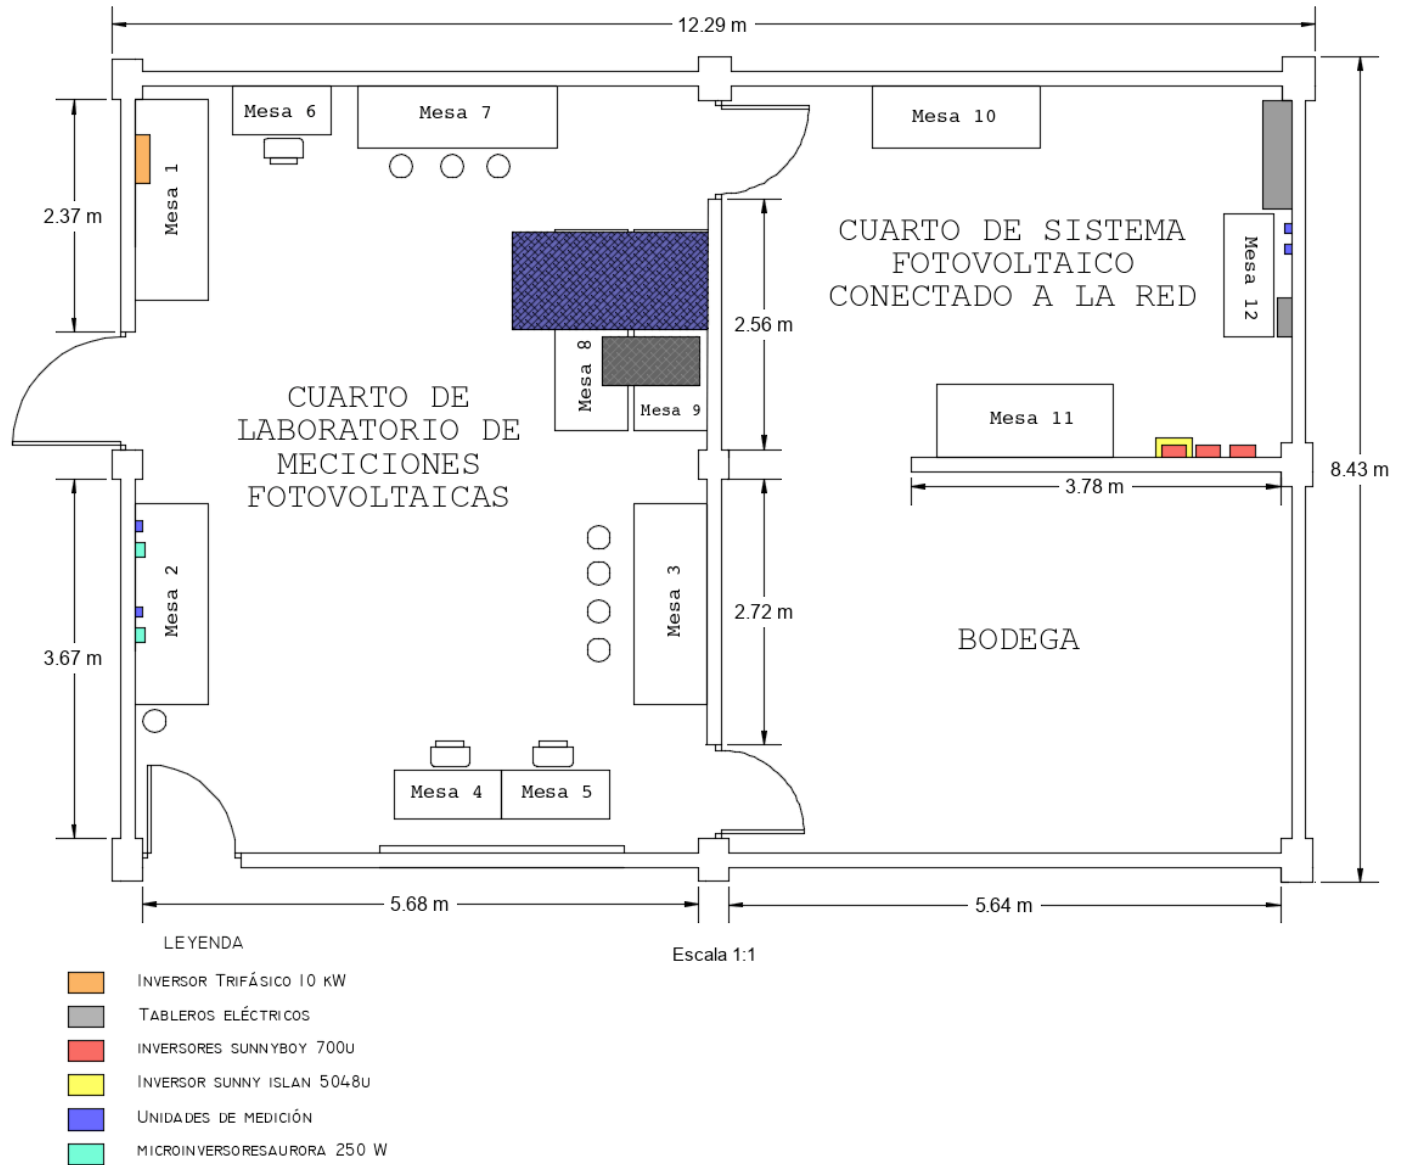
Plano de levantamiento de las instalaciones de laboratorio de generación fotovoltaica, Escuela de Ingeniería Eléctrica.
